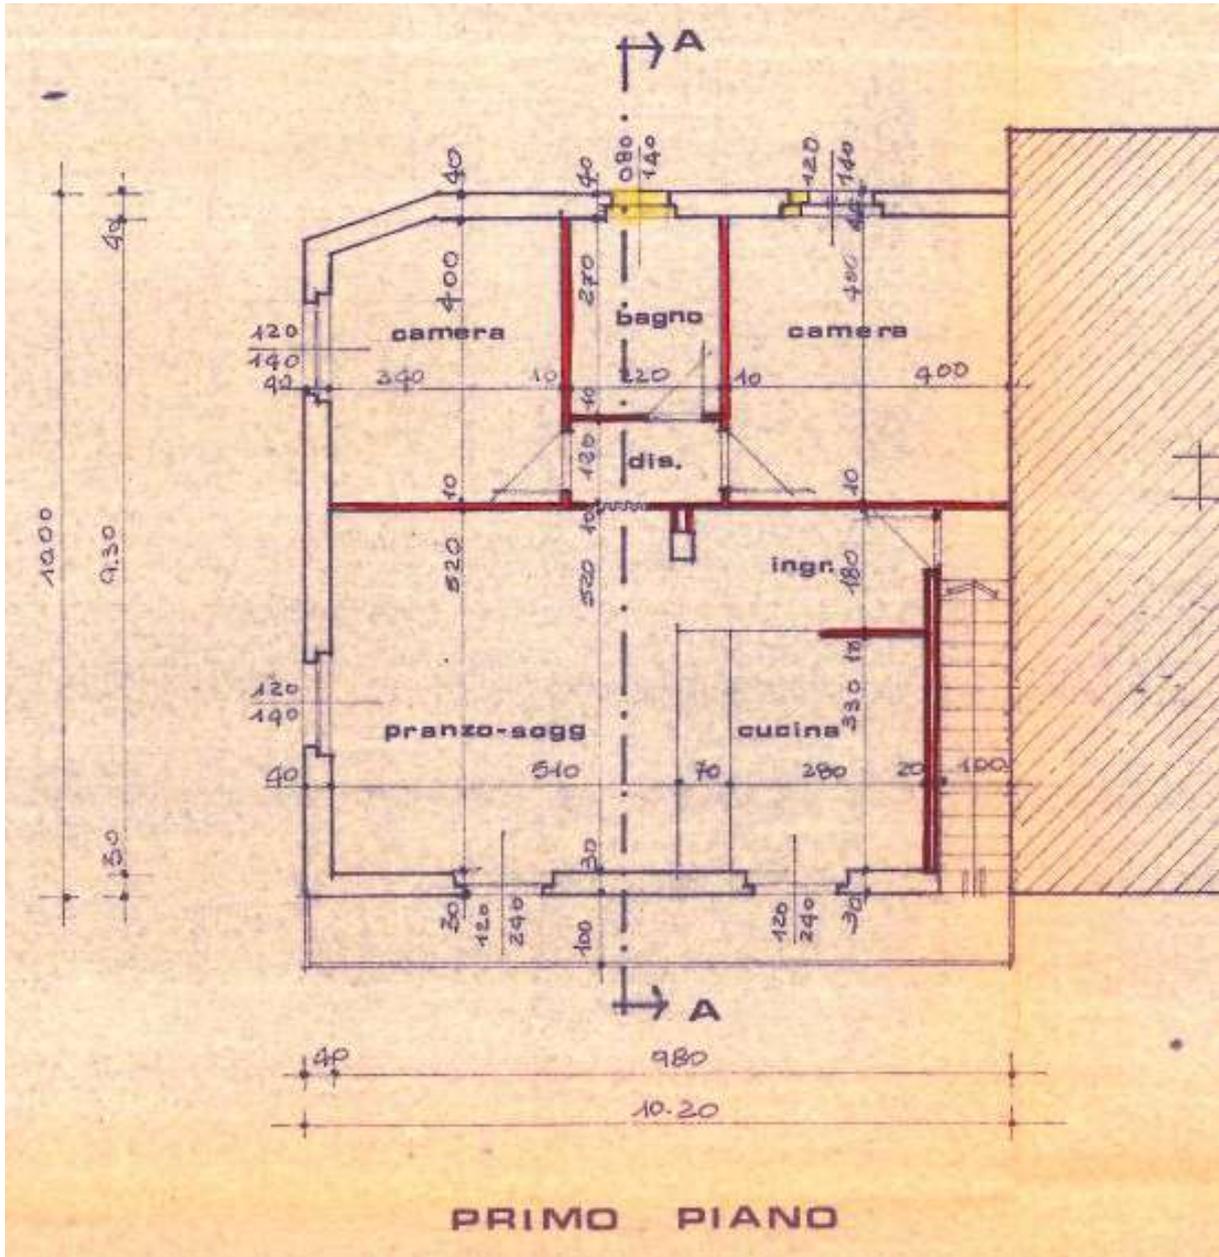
Concessione Edilizia n°2416 prot. n°5737 del 05/12/1985 stralcio tavola di progetto del piano primo con cambio di destinazione d'uso e formazione dell'immobile a destinazione residenziale (appartamento).
